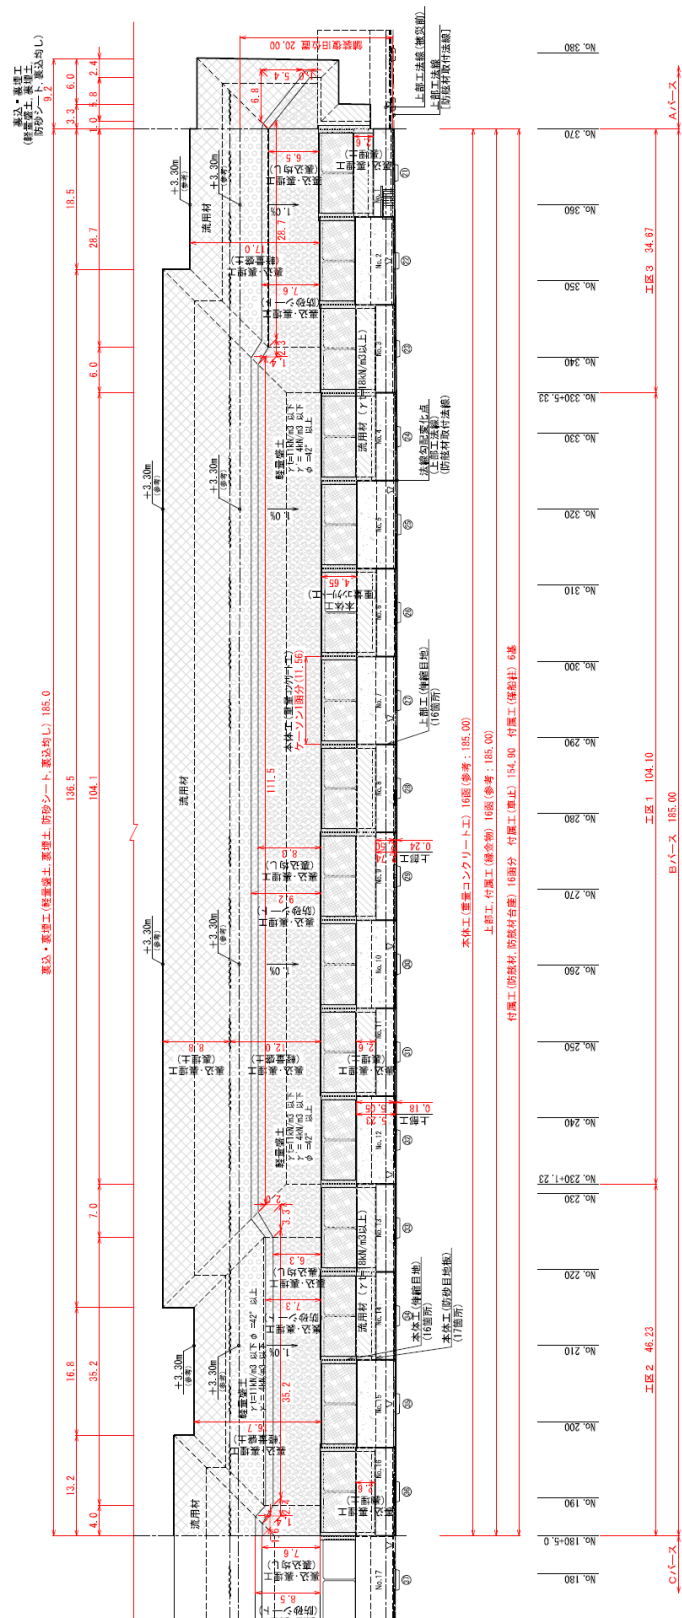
54 No.1 日立港区\_第5ふ頭地区岸壁(-10m)Bの平面図 (復旧後)
